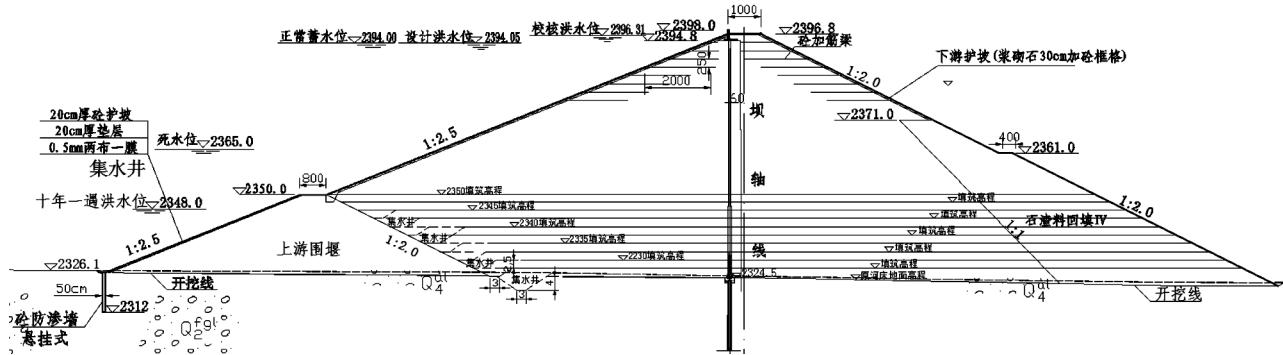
方案二：围堰基础悬挂式防渗墙设计及施工布置横断面图
